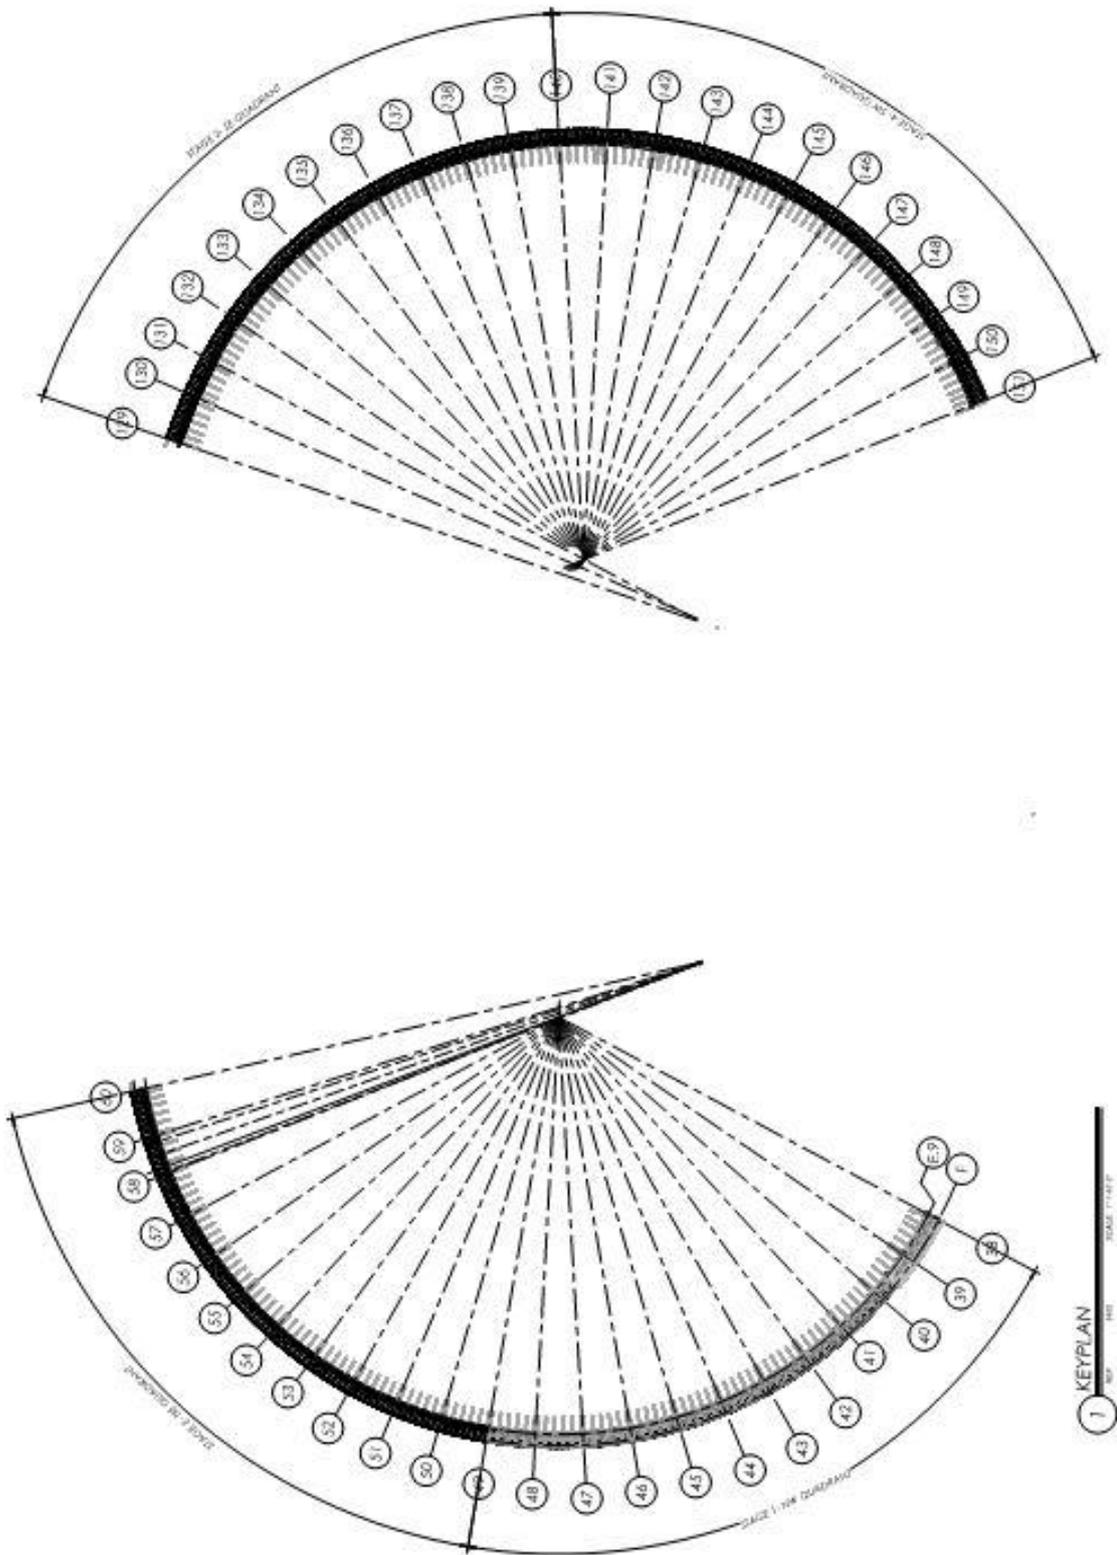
Planta general del proyecto. En ella se pueden ver las 4 zonas generales en las que se dividió el modelo
